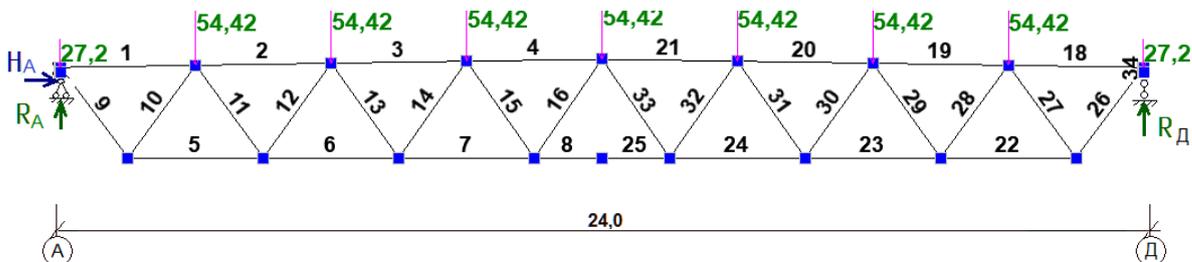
Расчетная схема с узловой нагрузкой из п. 2.2.3
